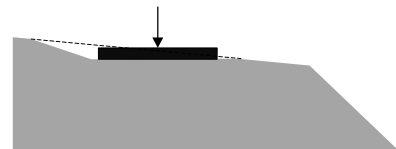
Schemaskizze zu den Plattendruckversuchen mit Sandausgleichsschicht (SA)
